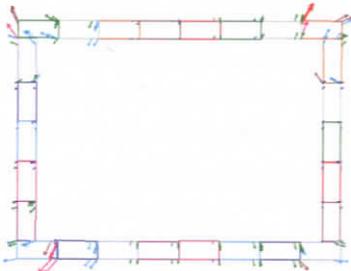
Cálculo com paredes e estruturas de madeira - Cota 15m (Desl. max.=26mm)
